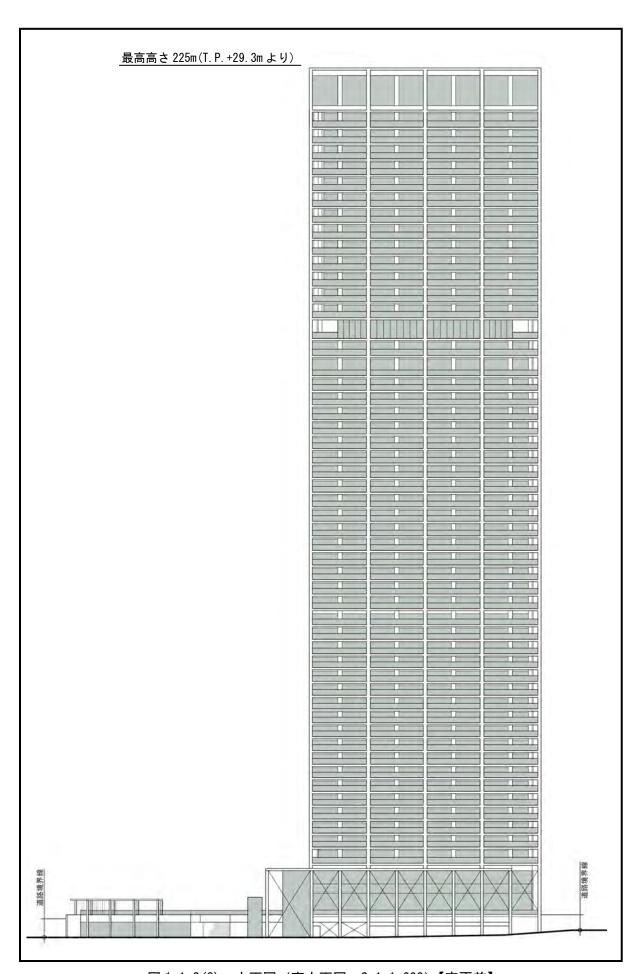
(3) 立面図 (東立面図 S=1:1,000) 【変更前】
